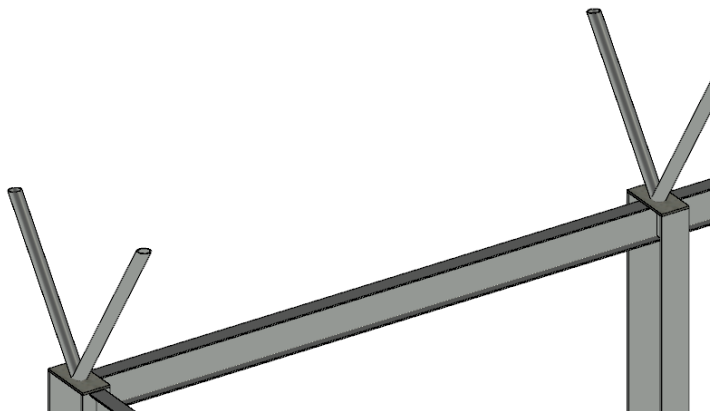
Placas de termino y soportes de armadura vista 3D (elaboración propia).
